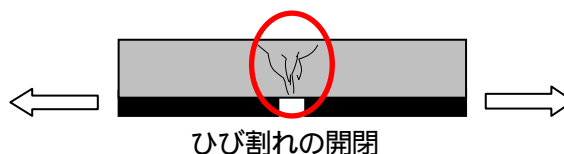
断面修復材のひび割れ追従性のイメージ
